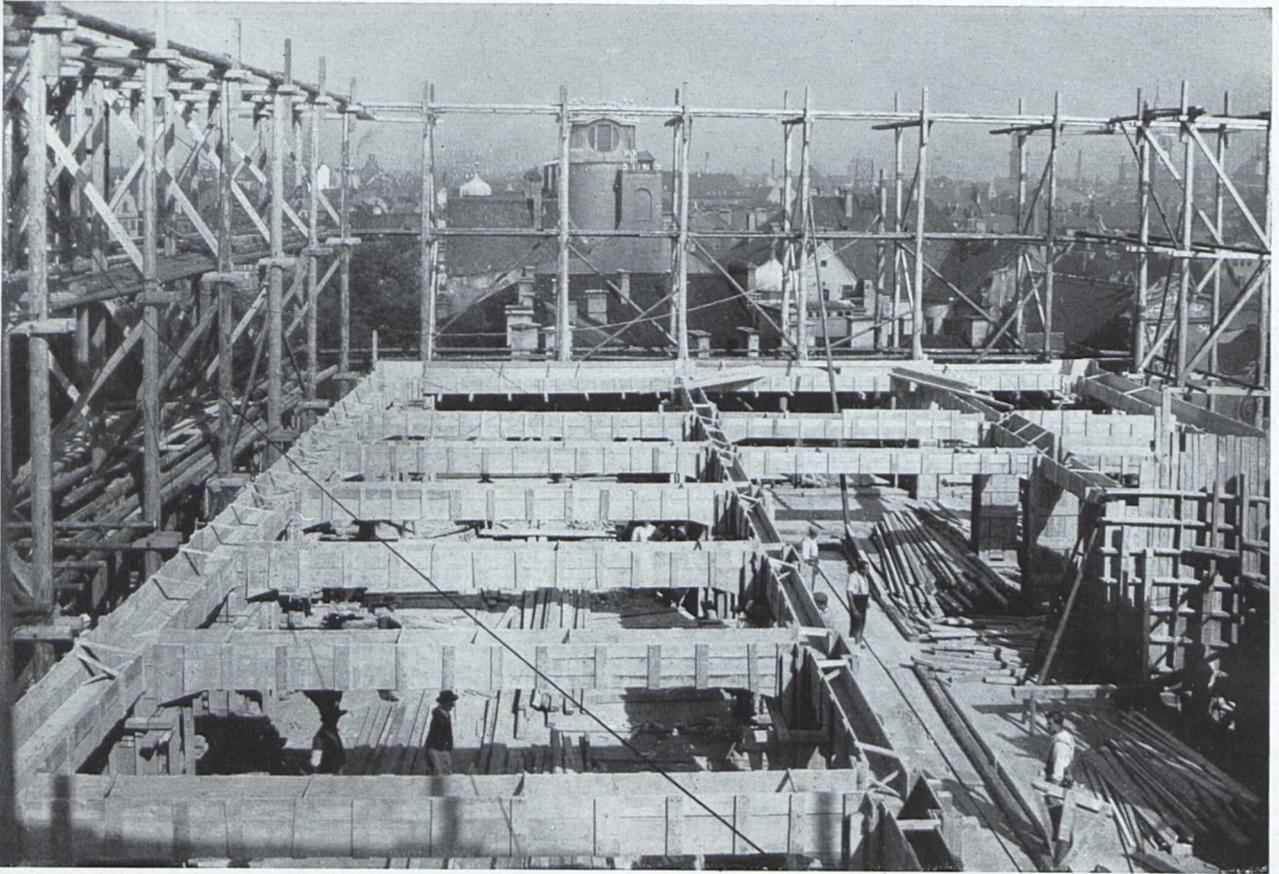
Bauausführung: Karl Stöhr, Bauunternehmung, München, Schwanthalerstraße 11
